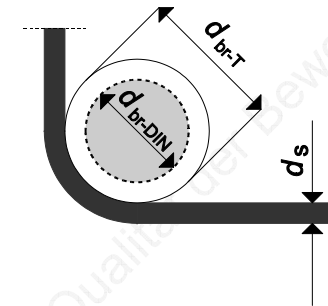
Toleranzen für Biegerollendurchmesser (Skizze unmaßstäblich)
